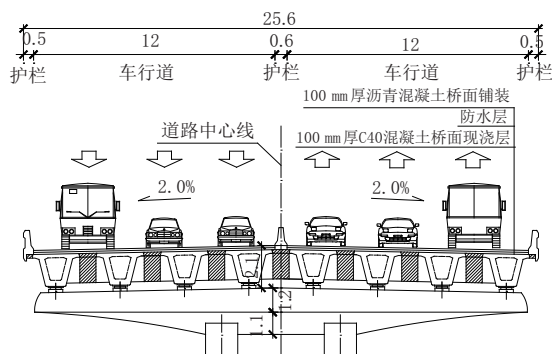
主线标准桥宽小箱梁横断面布置图(单位:m)
